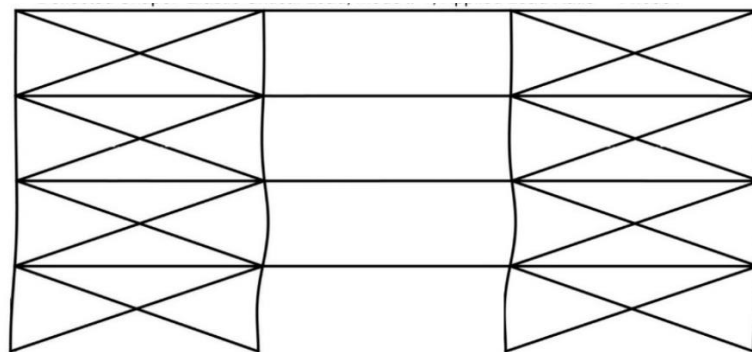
Exemplo de pórtico reforçado com sistema de contraventamento (SARAIVA, 2018)
